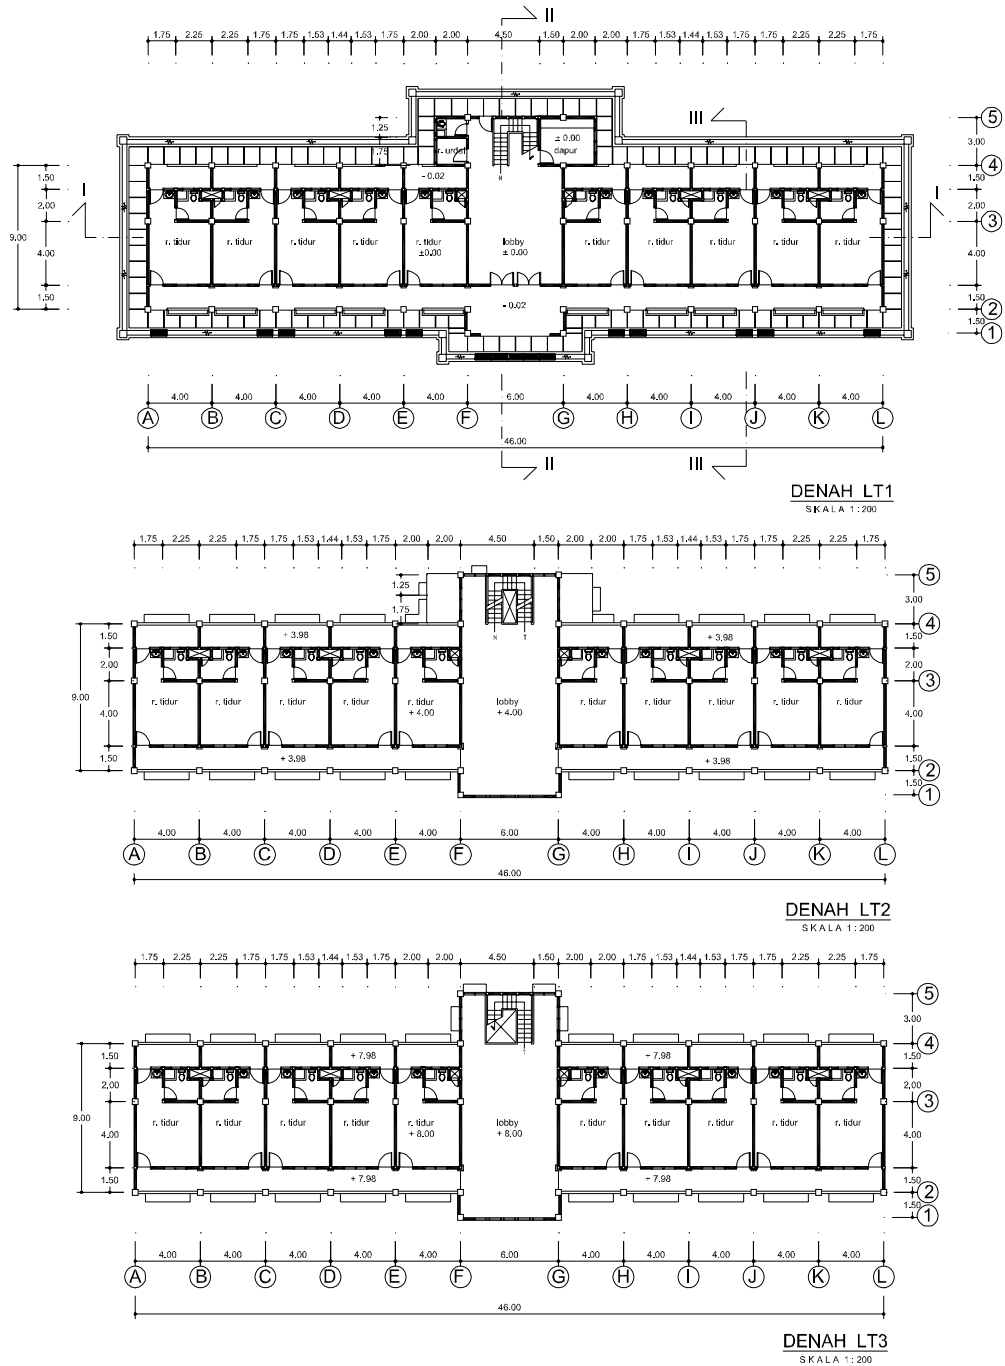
Denah Situasi Pembangunan Mess Pamen Jatirangga
